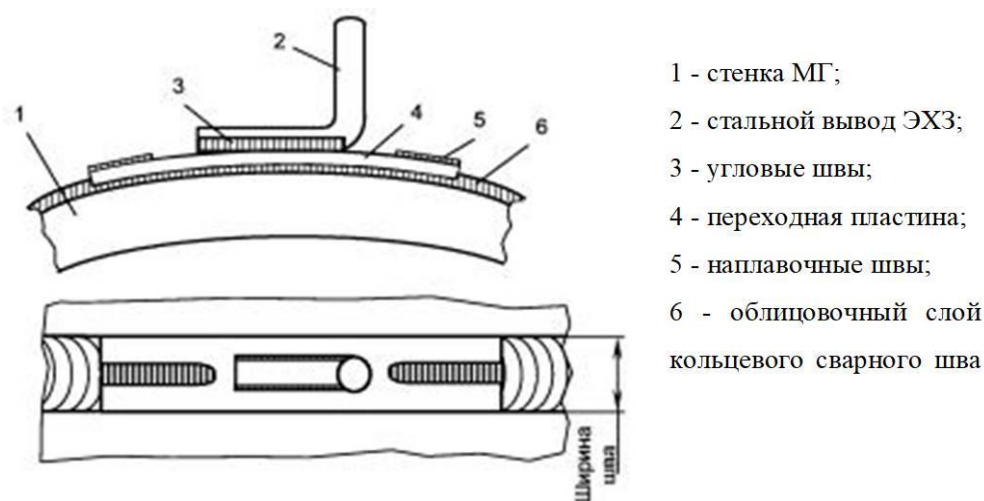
Схема приварки вывода ЭХЗ к кольцевому стыковому сварному шву МГ через ПП
